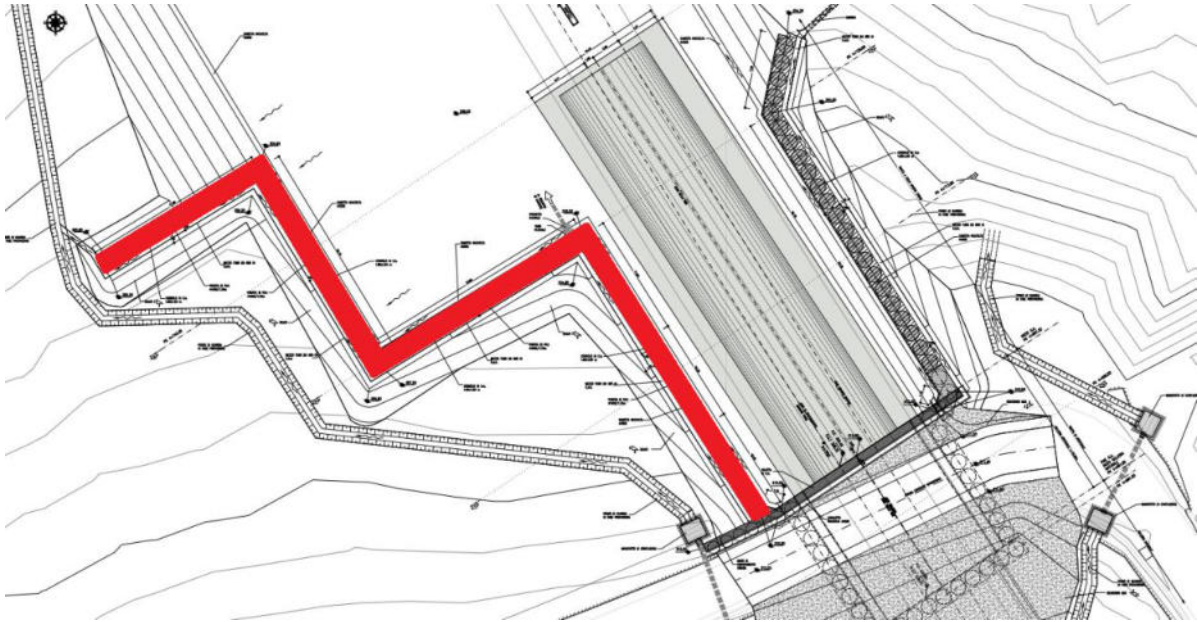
Stralcio Planimetria Generale PE imbocco GI02 - IF2801EZZLAGA0200001
